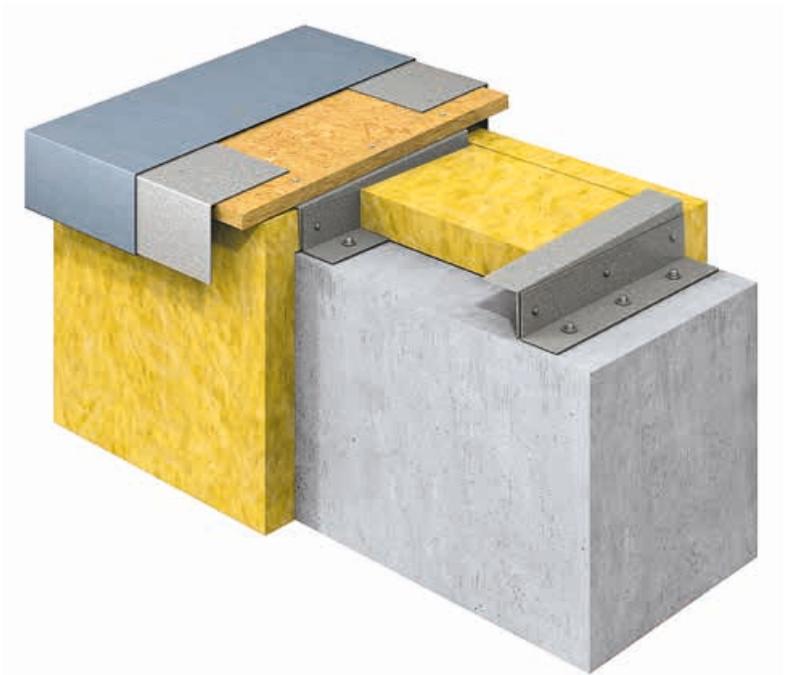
La albardilla para muro con subestructura metálica de multisección, ofrece beneficios por compensación de tolerancia.
